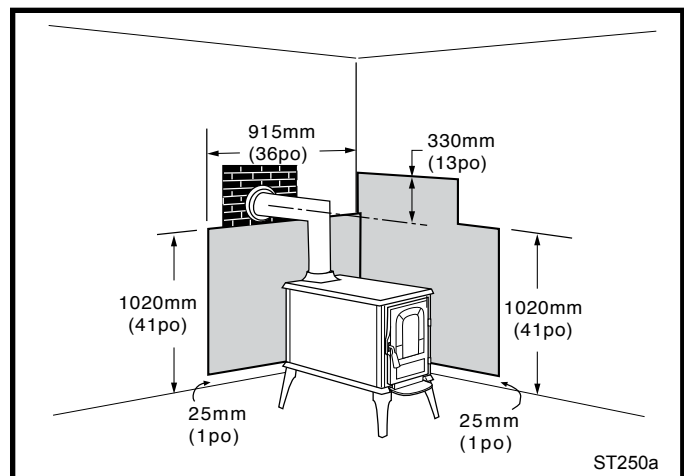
Installation parallèle avec traversée murale arrière et double écran mural pare-chaueur.
